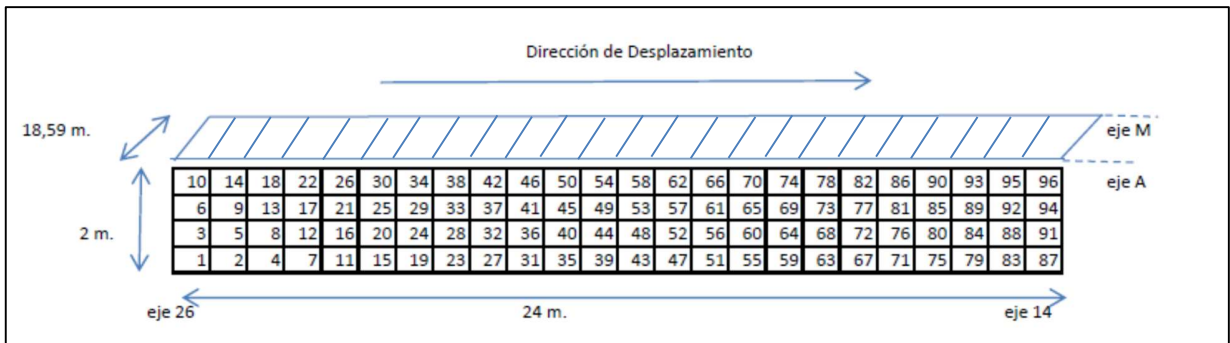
SECUENCIA DE HORMIGONADO
